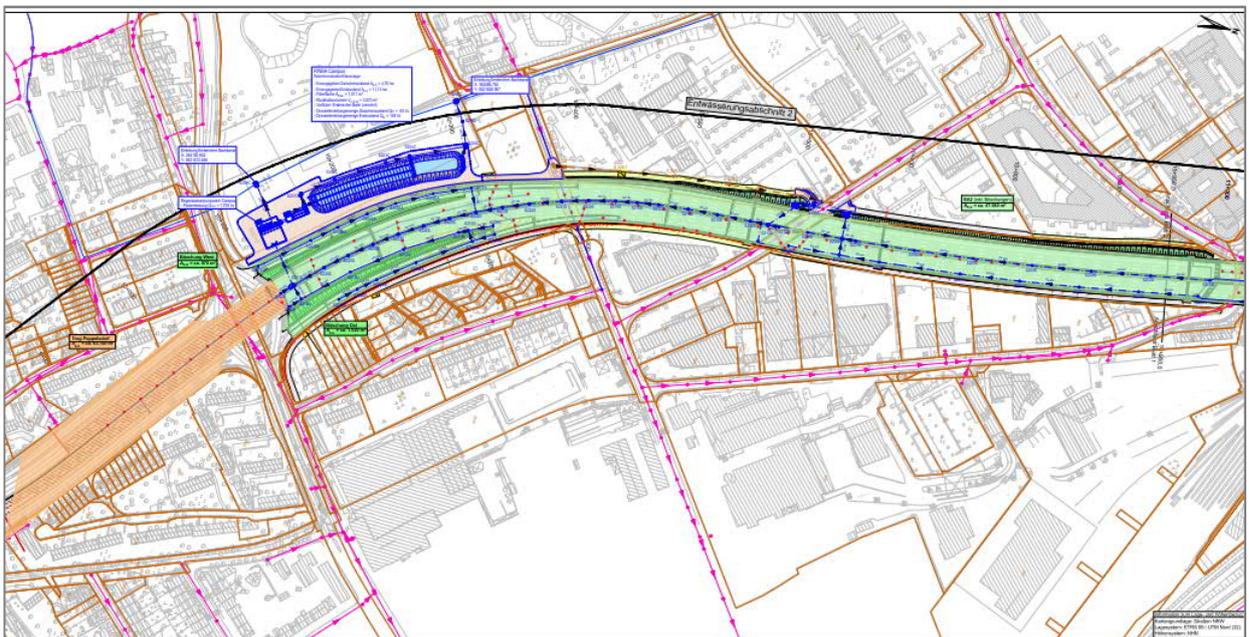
Lageplan südlicher Entwässerungsabschnitt EA2 mit Pumpwerk, RWBA Campus und Einleitung in den Endericher Bach (verrohrt Gewässer) (Quelle: Unterlage 8.1/1)
